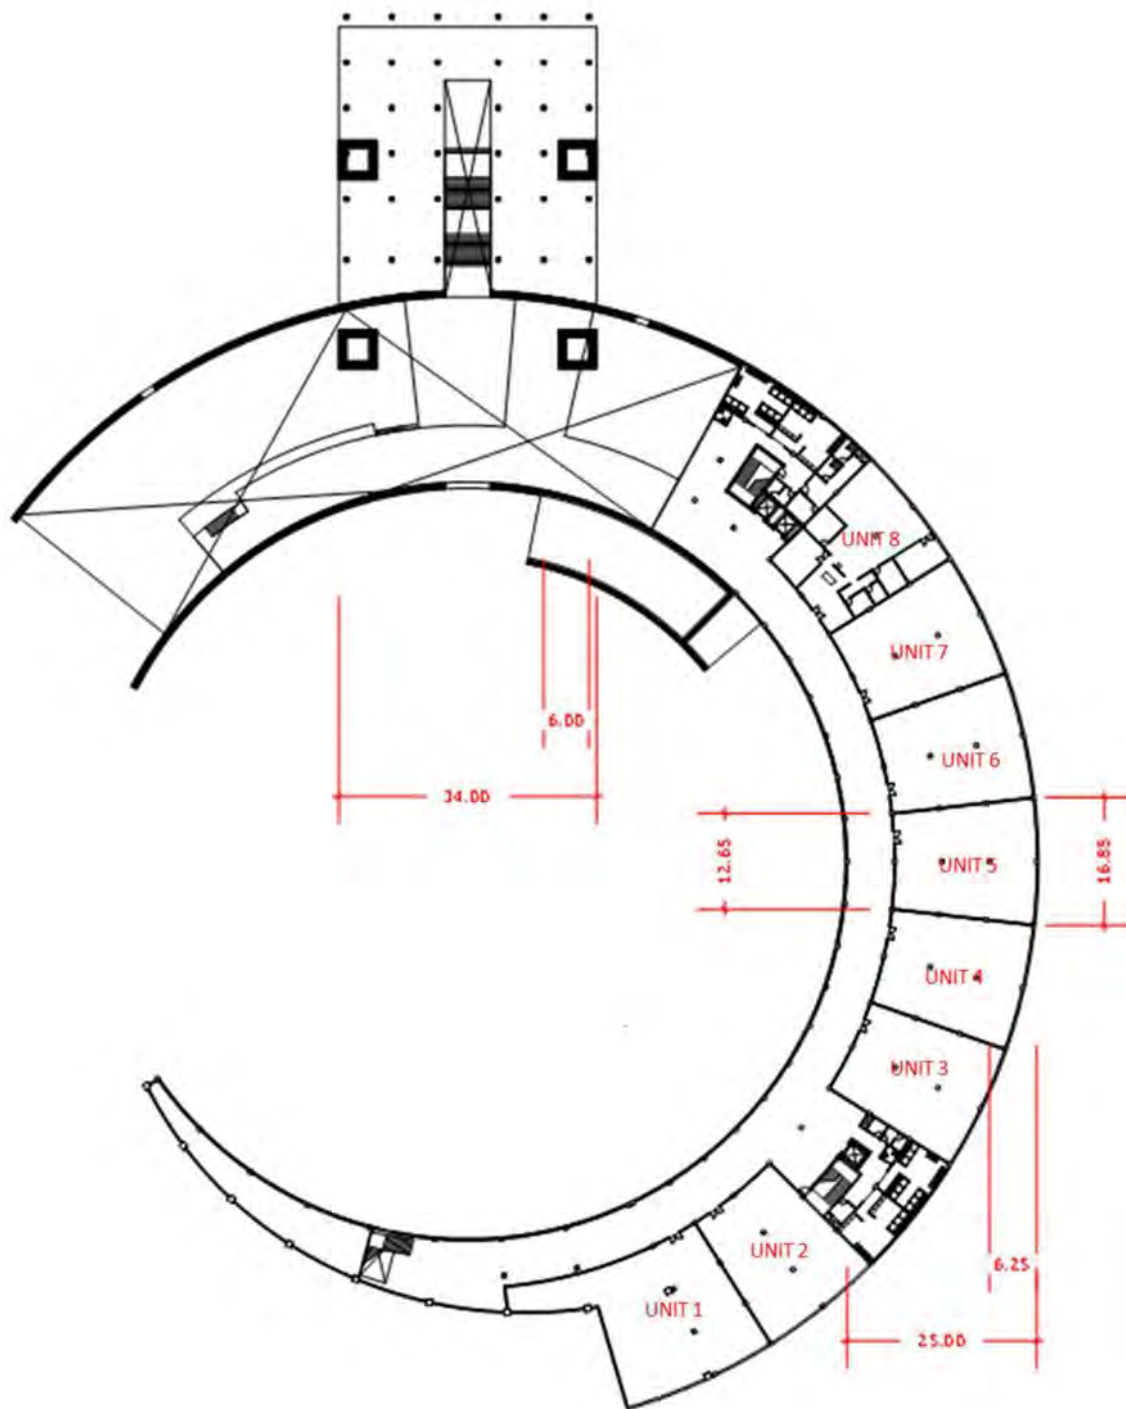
Denah lantai 2 (dok.pribadi)
